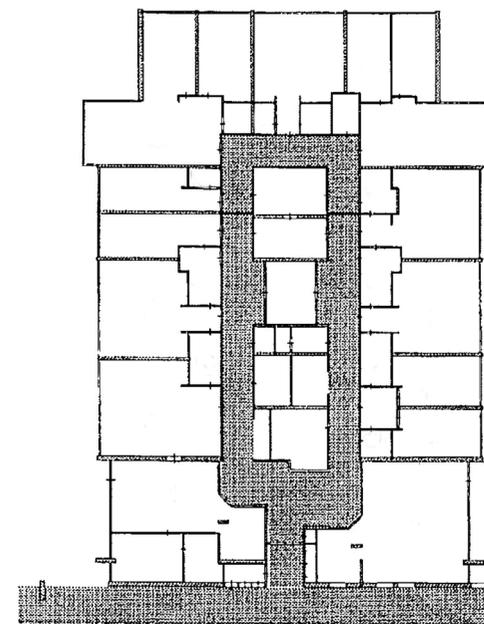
Grundriss einer Station des De Bleerick Pflegeheimes
